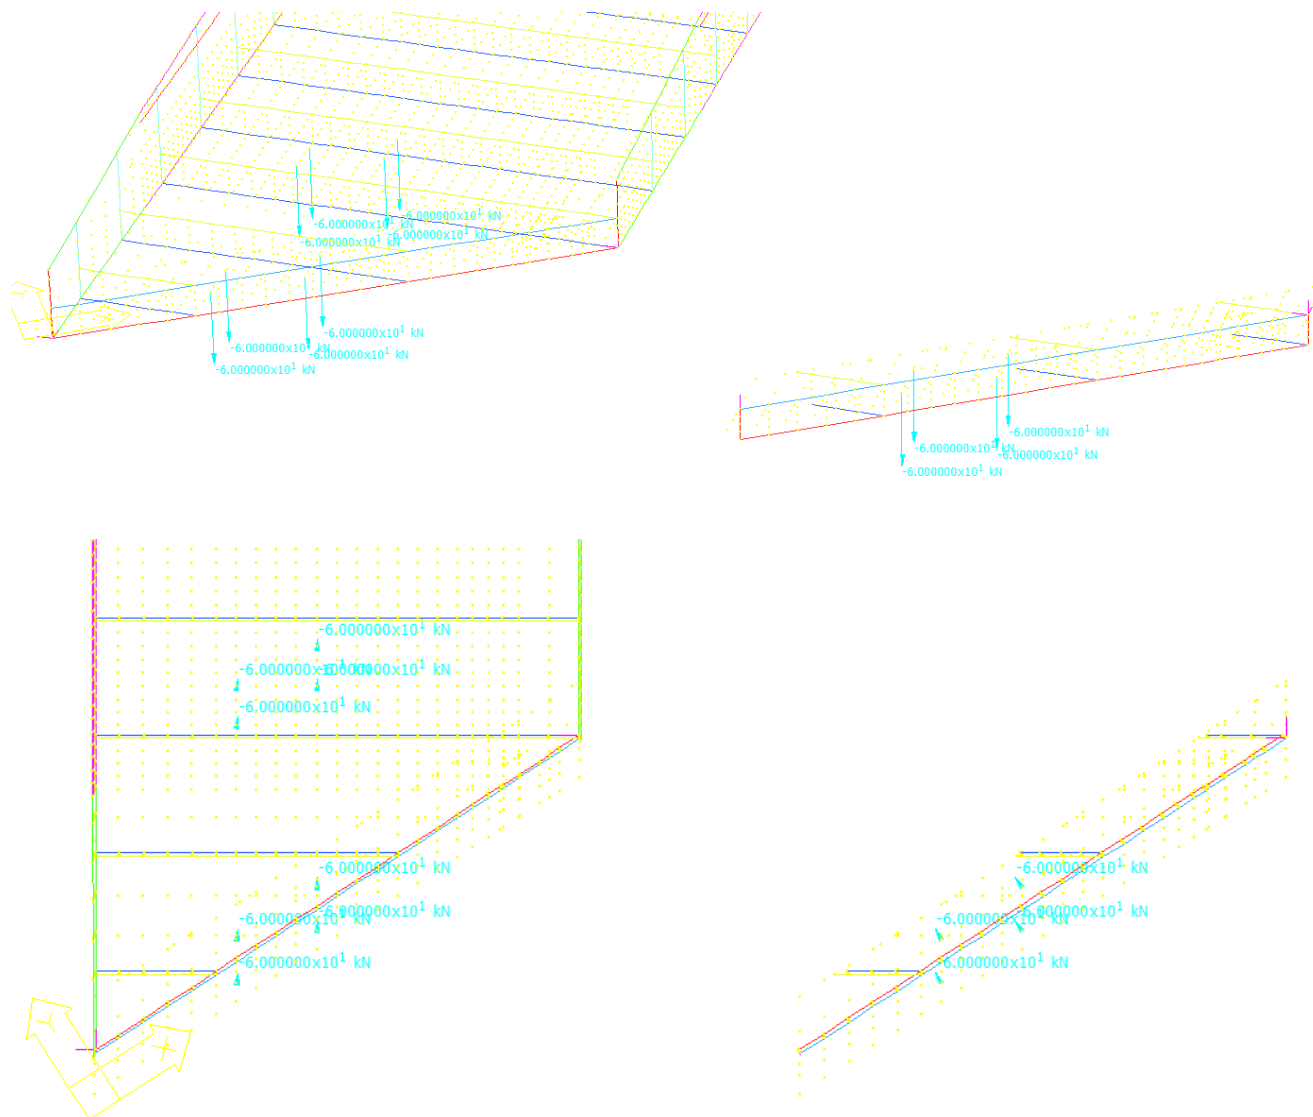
Modello tridimensionale dell'intero impalcato e del traverso isolato. Vista 3D e planimetria della disposizione dei carichi
